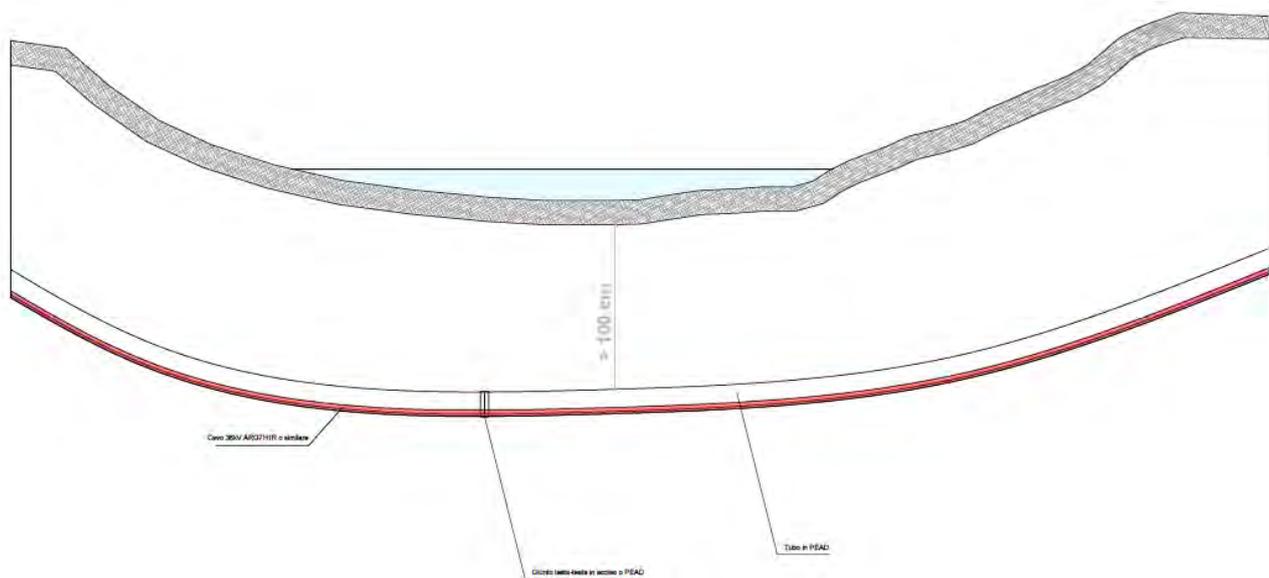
Sezione longitudinale di attraversamento in TOC di canali e fossati
